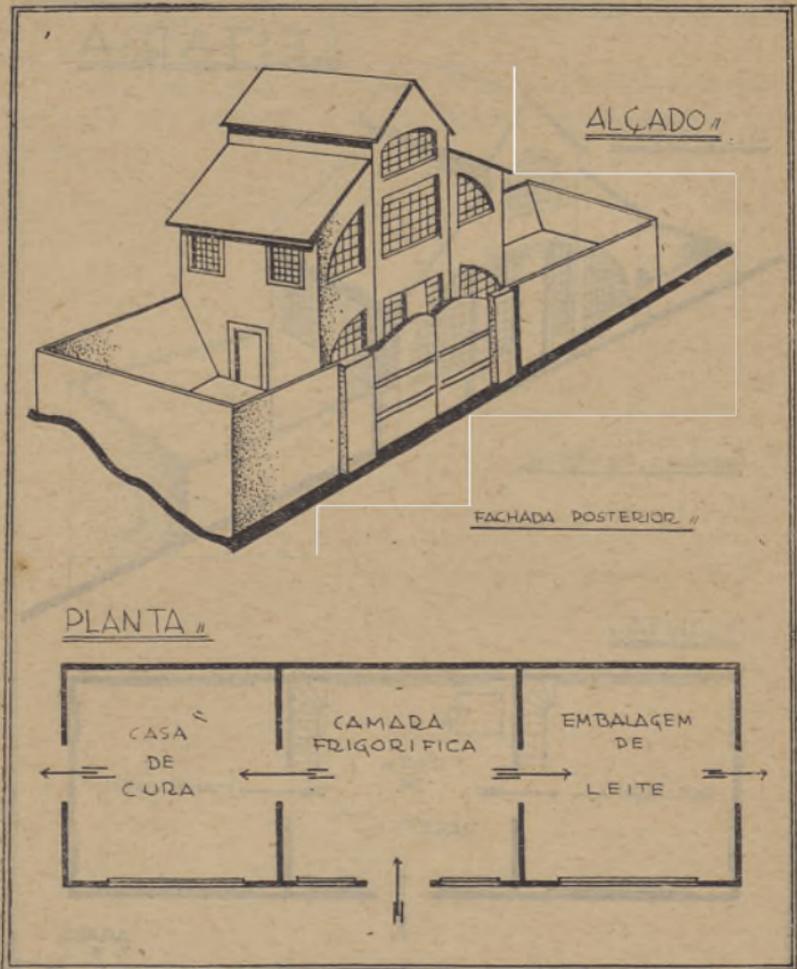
Alçado e planta de uma leitaria. Fachada posterior e planta do rez do chão
